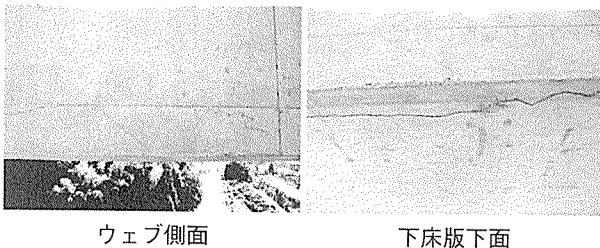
カブラシースの配置不良により発生したひび割れ
